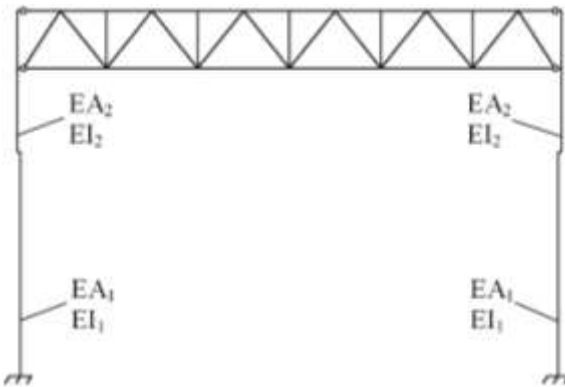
Расчетная схема поперечной рамы с ригелем в виде фермы, жестко сопряженной с колоннами.
